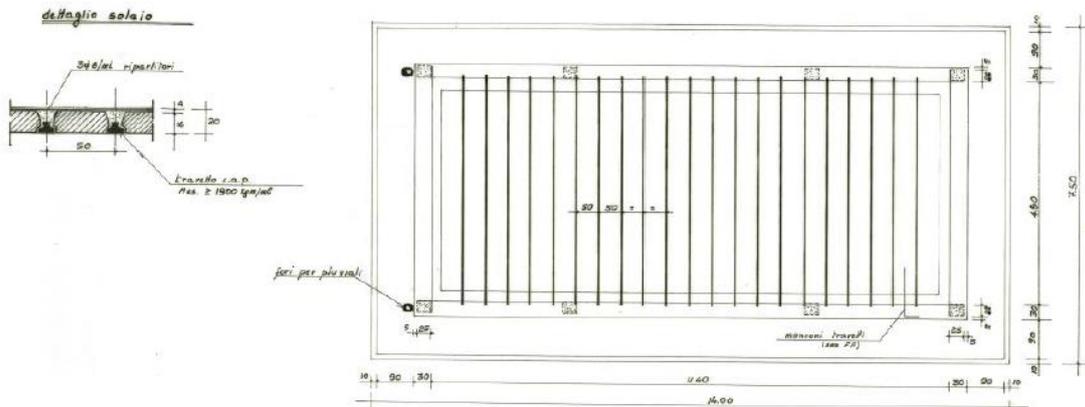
Cabina Elettrica 12 – Documentazione di progetto (Copertura - Pianta e Dettagli)
